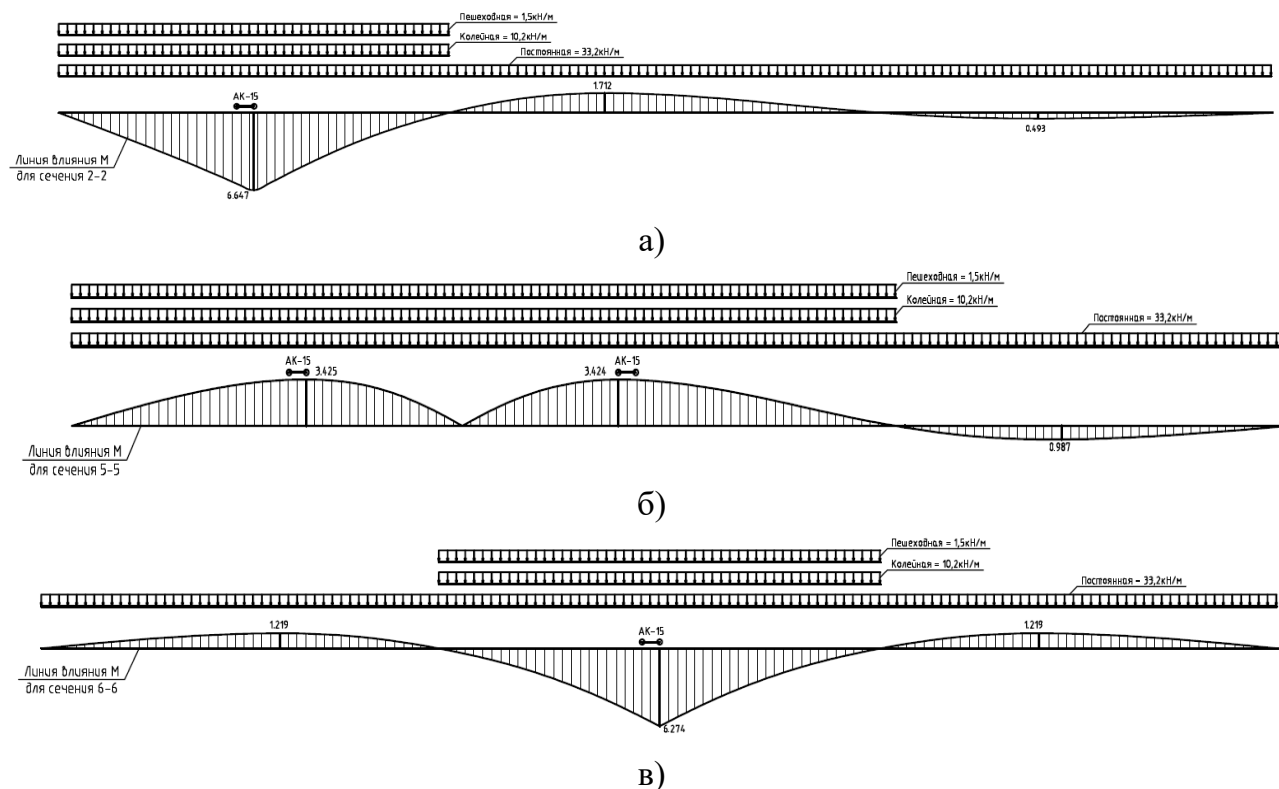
Схемы загрузки линий влияния нагрузкой А-15 и толпой пешеходов для определения наибольшего: а) изгибающего момента в первом пролете; б) изгибающего момента над первой промежуточной опорой; в) изгибающего момента во втором пролете
